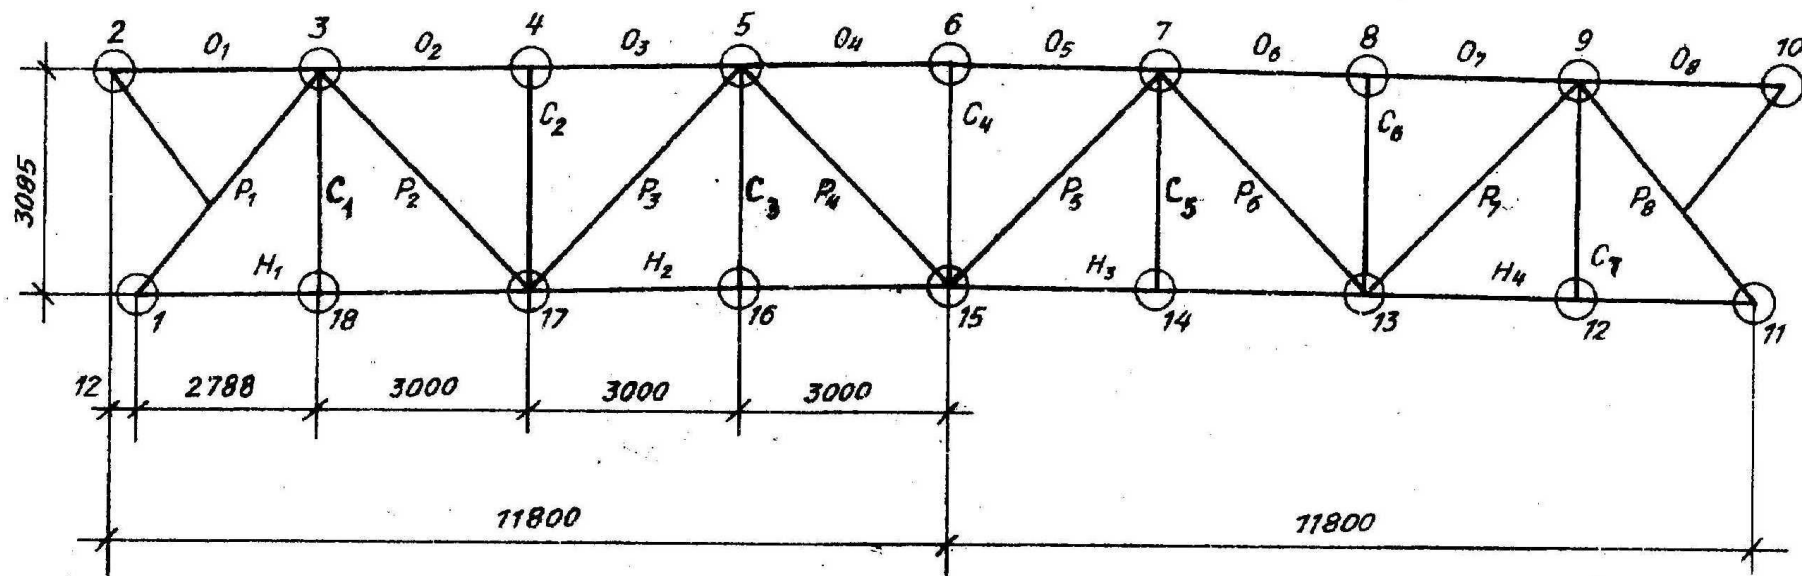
Геометрическая схема фермы ФС-24-3,85 D1; ФС-24-3,85 D2;
